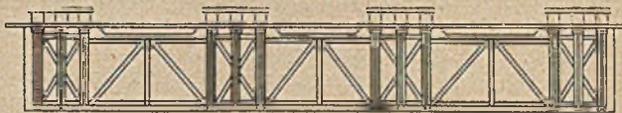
Entwurf Elbbrücke Dresden. Querschnitt durch eine an die Gitterträger angehängte Lamelle des Hauptbogens.
